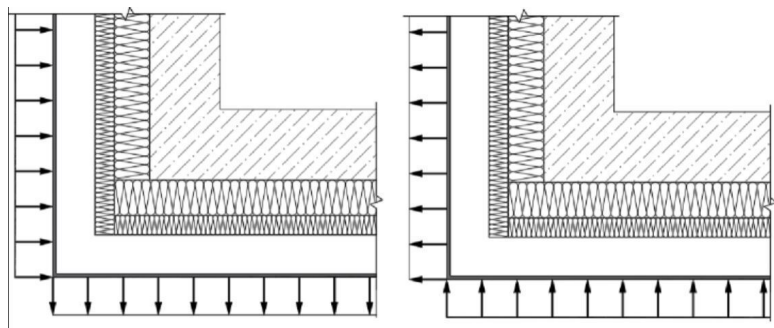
Действие ветровой нагрузки в угловой зоне фасада
